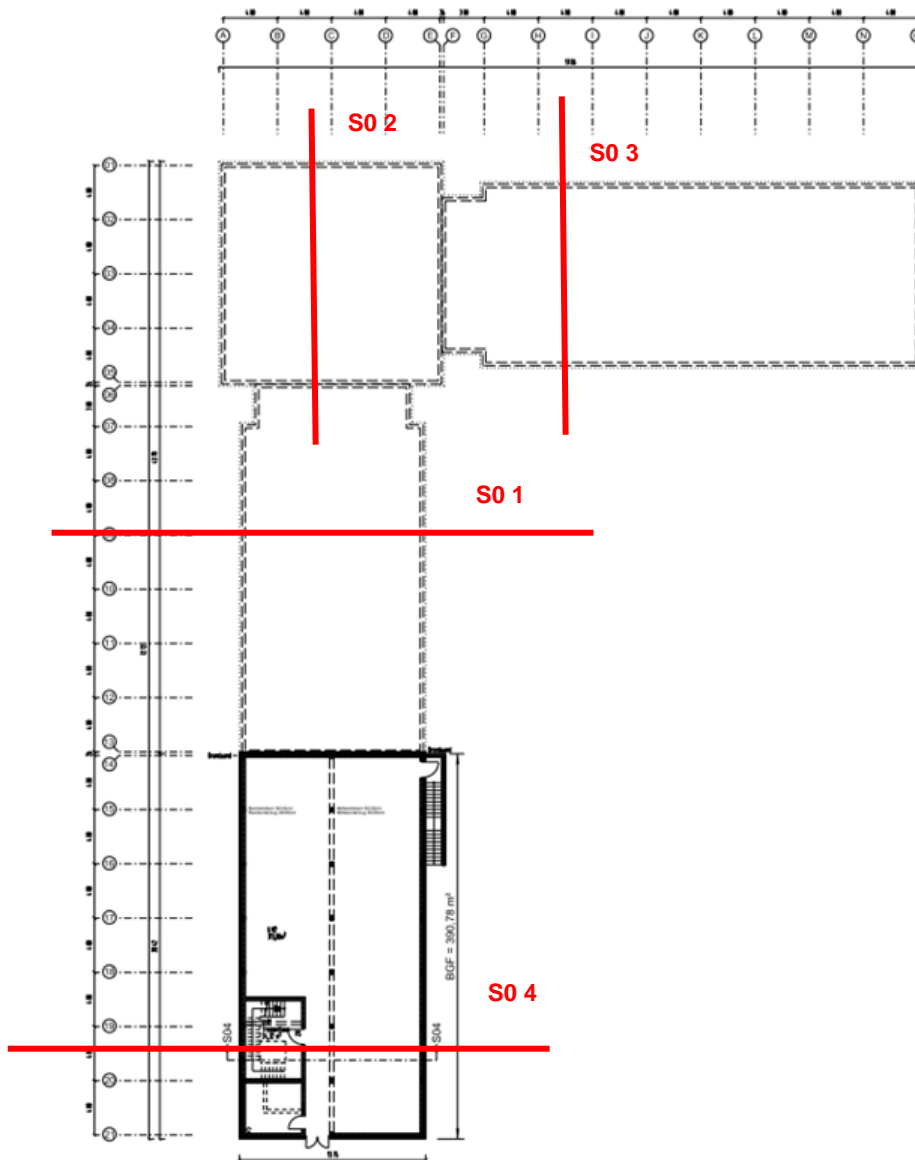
Grundriss mit Lage Schnitte [3]
